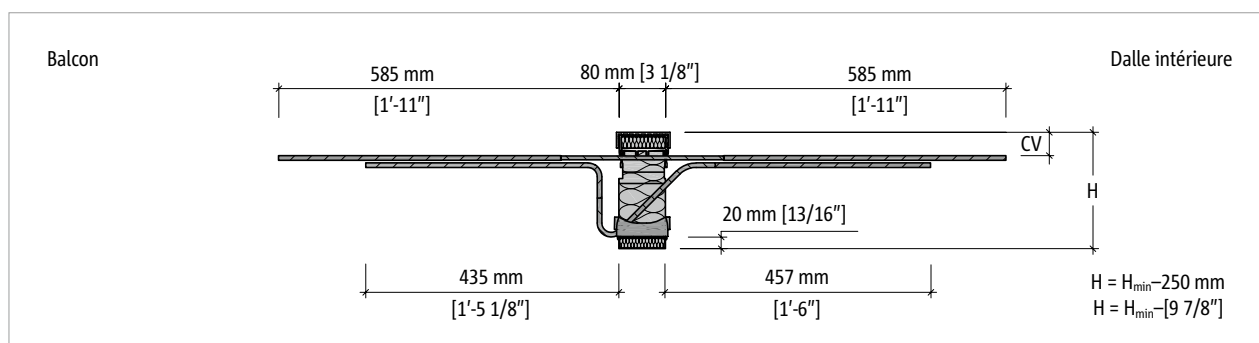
Schöck Isokorb® T Type CK-M1-V1 à M6-V2 : coupe transversale du produit
